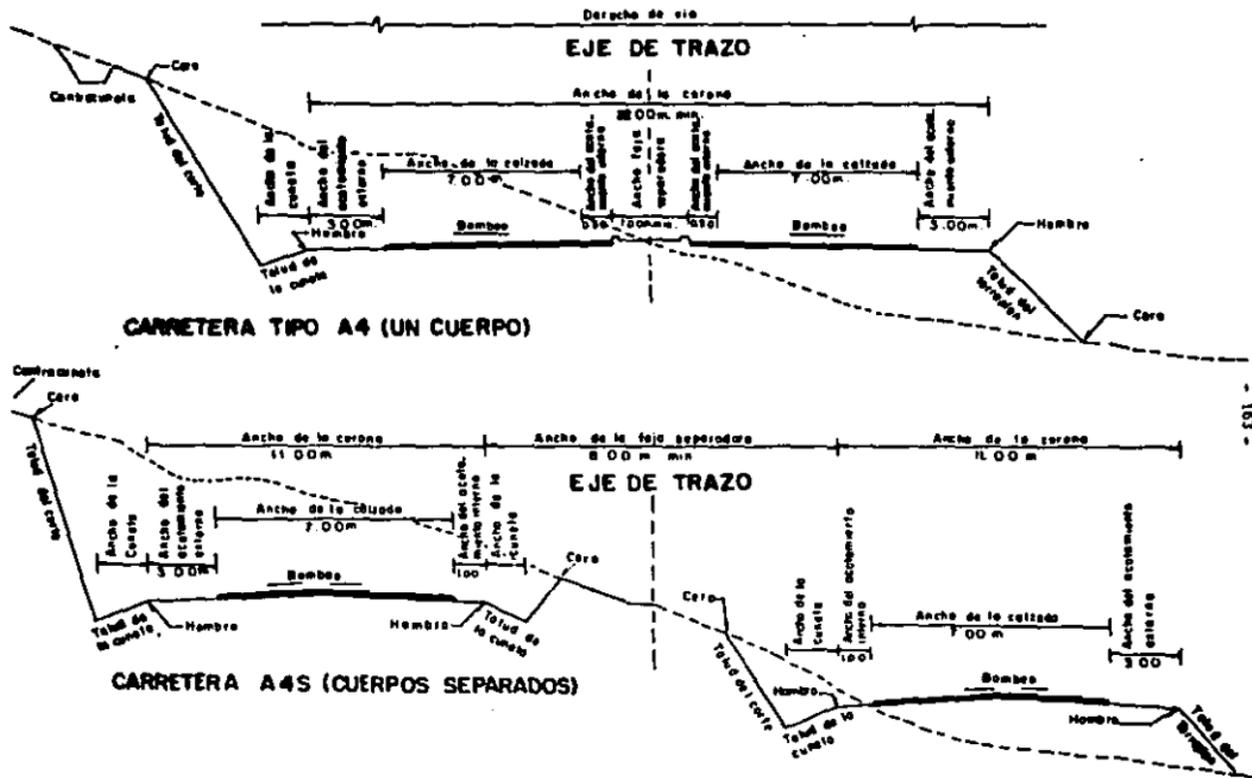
SECCION TRANSVERSAL EN TANGENTE DEL ALINEAMIENTO HORIZONTAL PARA CARRETERA TIPO A4S.
